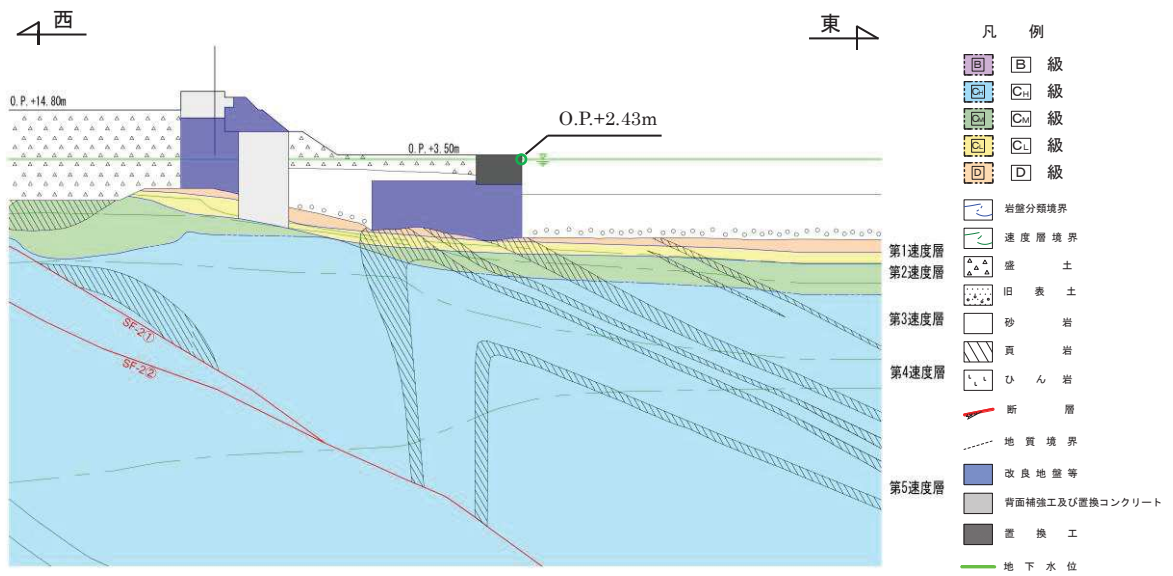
前面護岸 評価対象地質断面図 (A-A断面)
